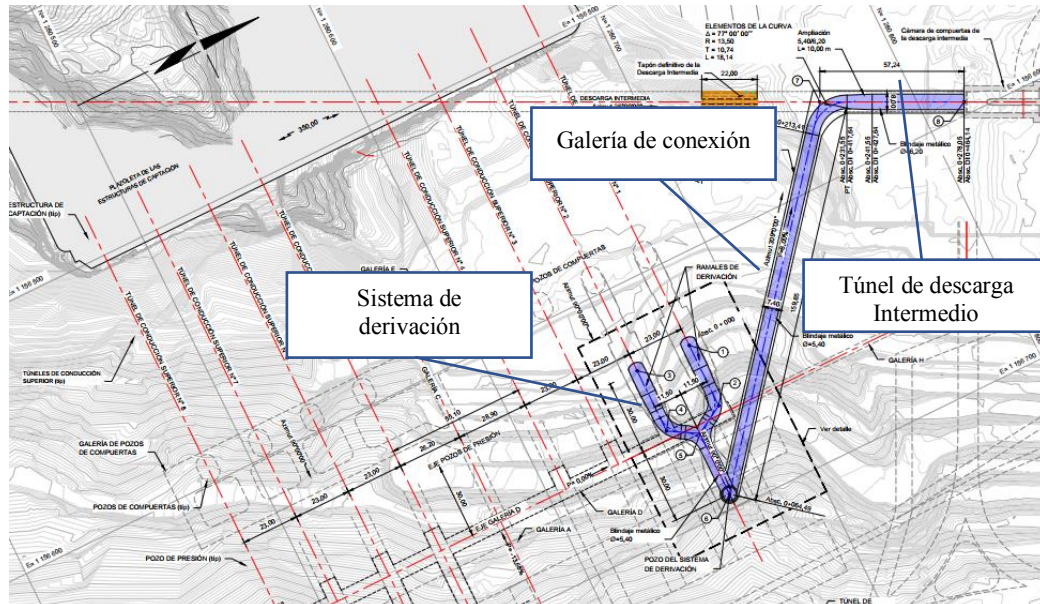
Vista en planta del sistema de derivación que conecta el túnel de conducción superior con el túnel de descarga intermedio
